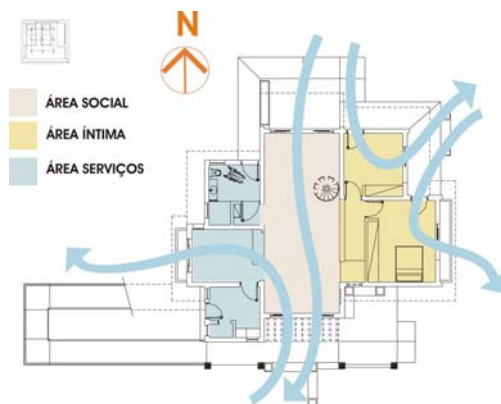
Planta baixa da Casa Eficiente, indicando o aproveitamento da ventilação predominante.
